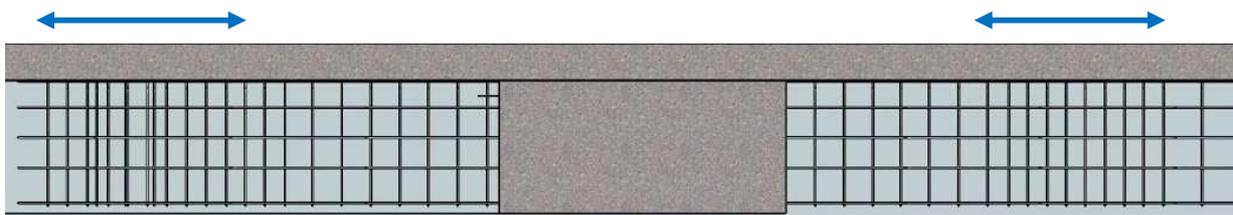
Représentation schématique du principe de ferrailage d'une fondation de type radier (élévation).
